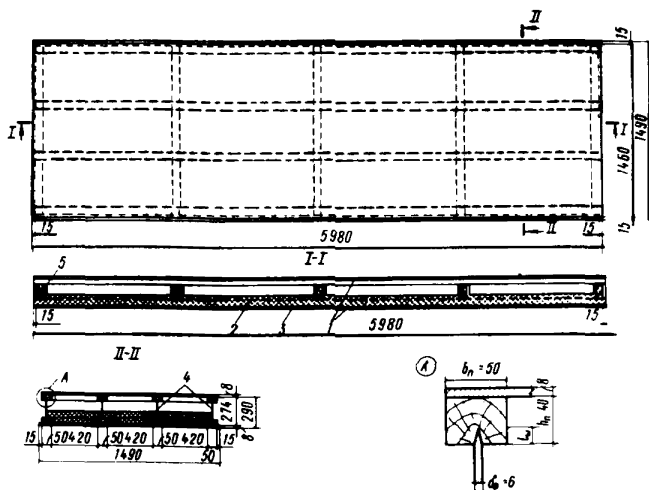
Плита покрытия с продольными ребрами из балок с плоской фанерной стенкой
